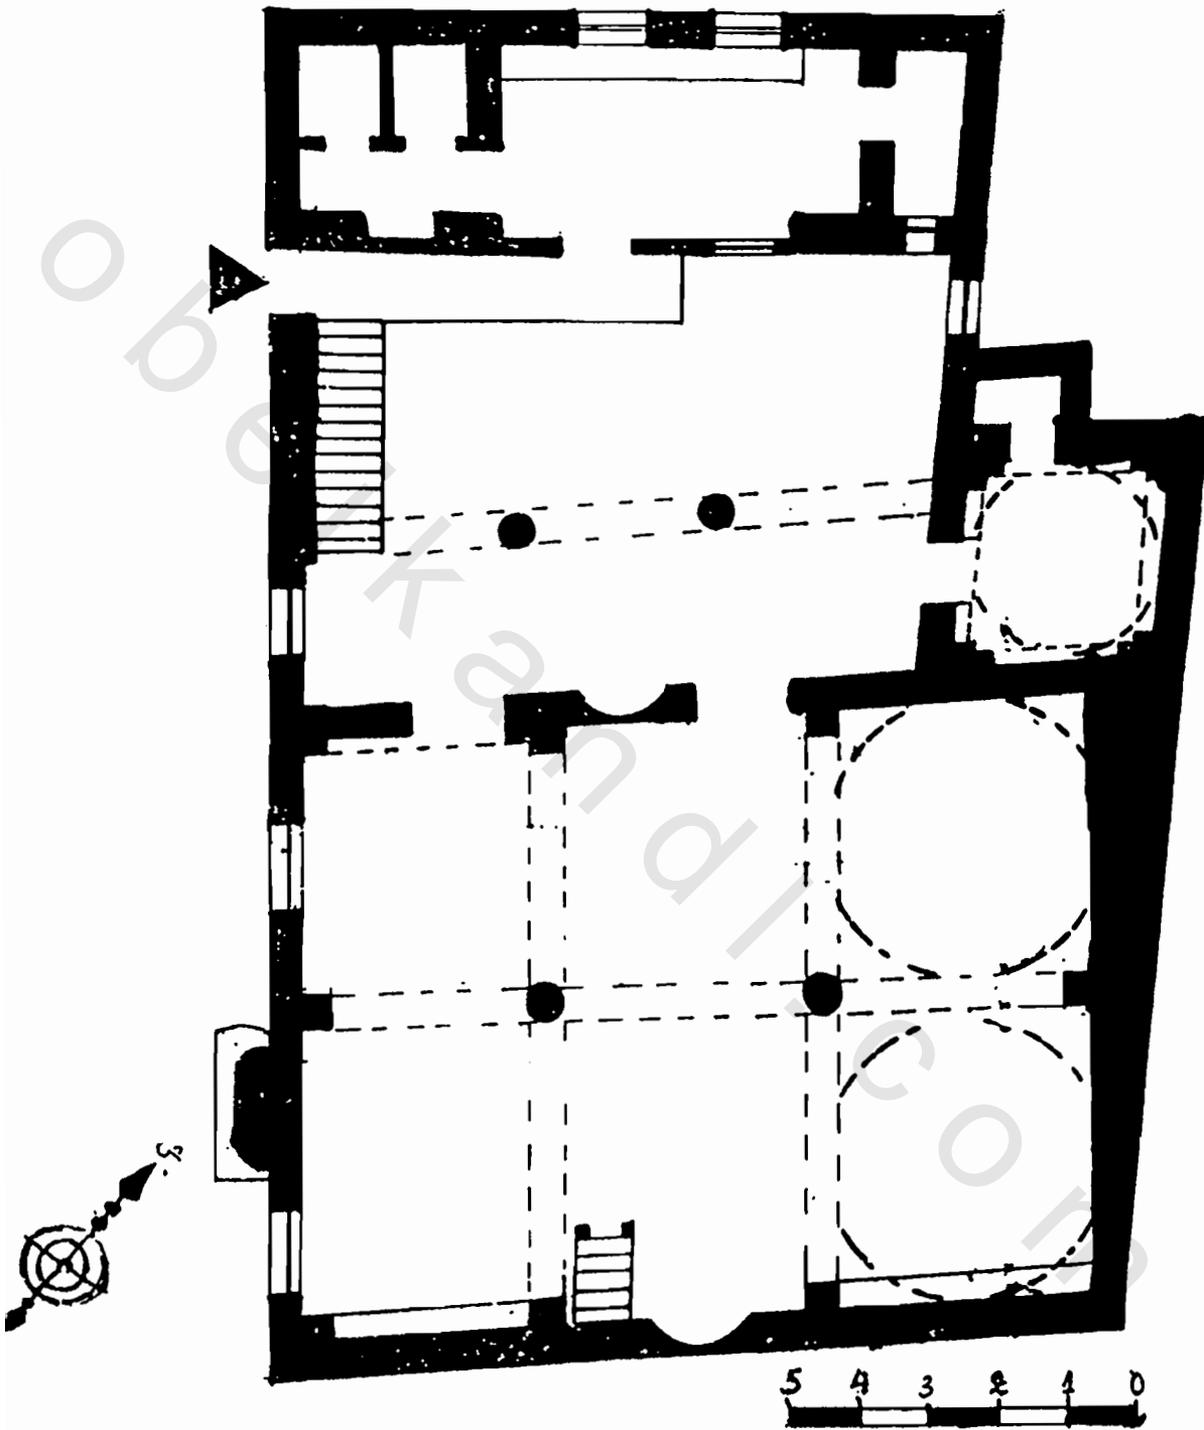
مسقط أفقي لمسجد قرة بغلي (النصف الثاني من القرن ١١هـ/١٧م)
